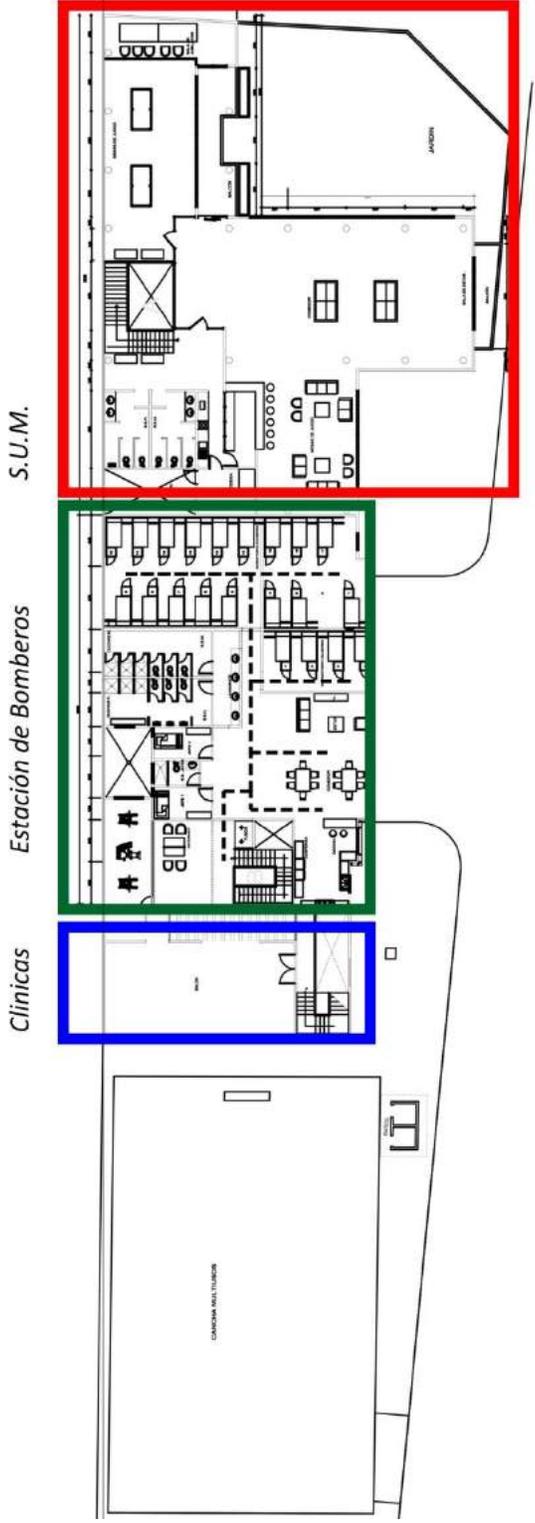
Planta segundo nivel CBM 7. Fuente: CBM. Edición: Zonificación elaboración propia
